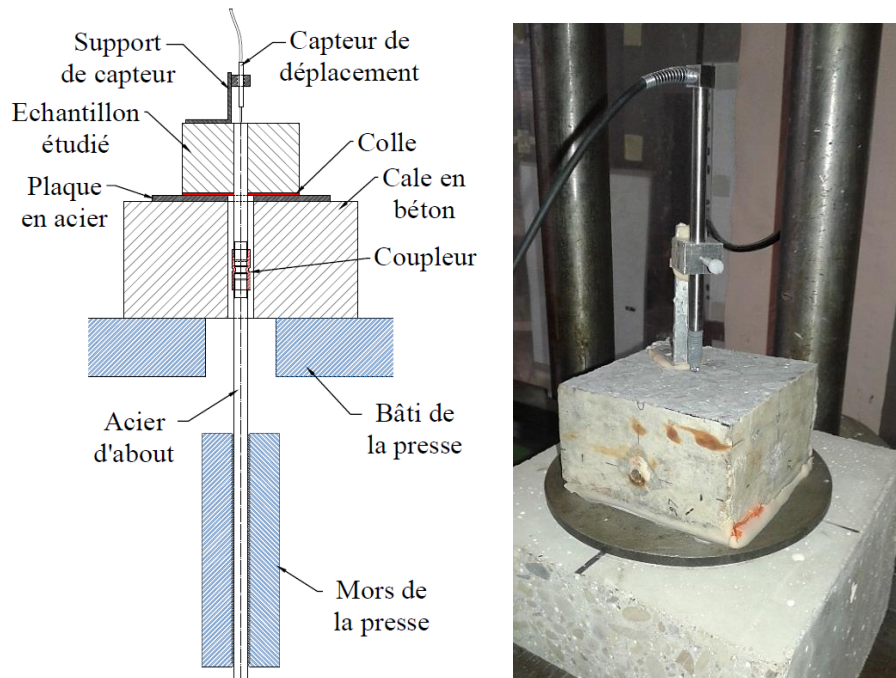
Seconde série d'essais de pull-out (rupture de l'interface acier-béton).
